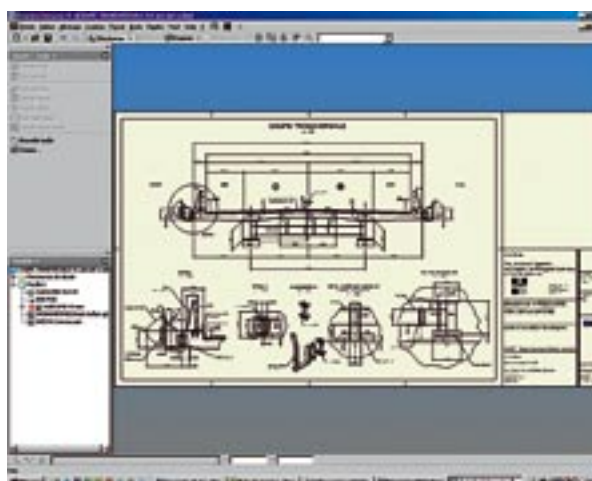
exemple de mise en plan 2D du pont de Fos sur la Garonne
